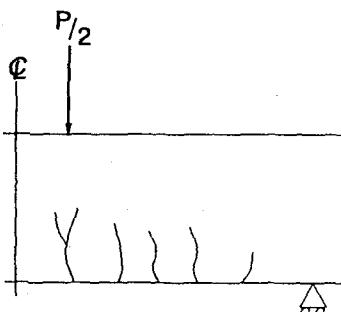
RCはりのひびわれ進展図（上部鉄筋0本）
